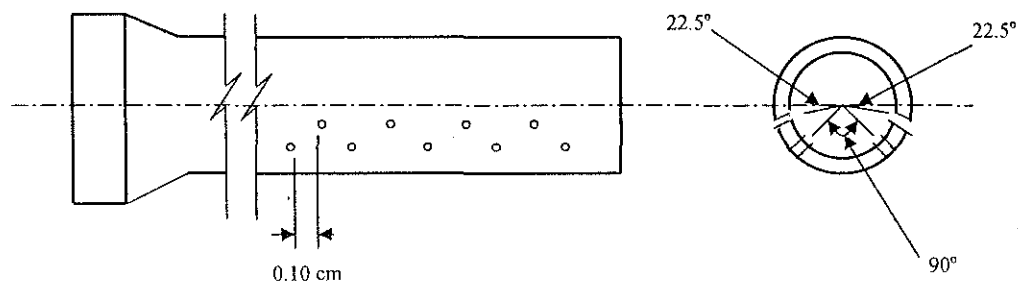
Disposición de las perforaciones en tuberías para subdrenaje.
